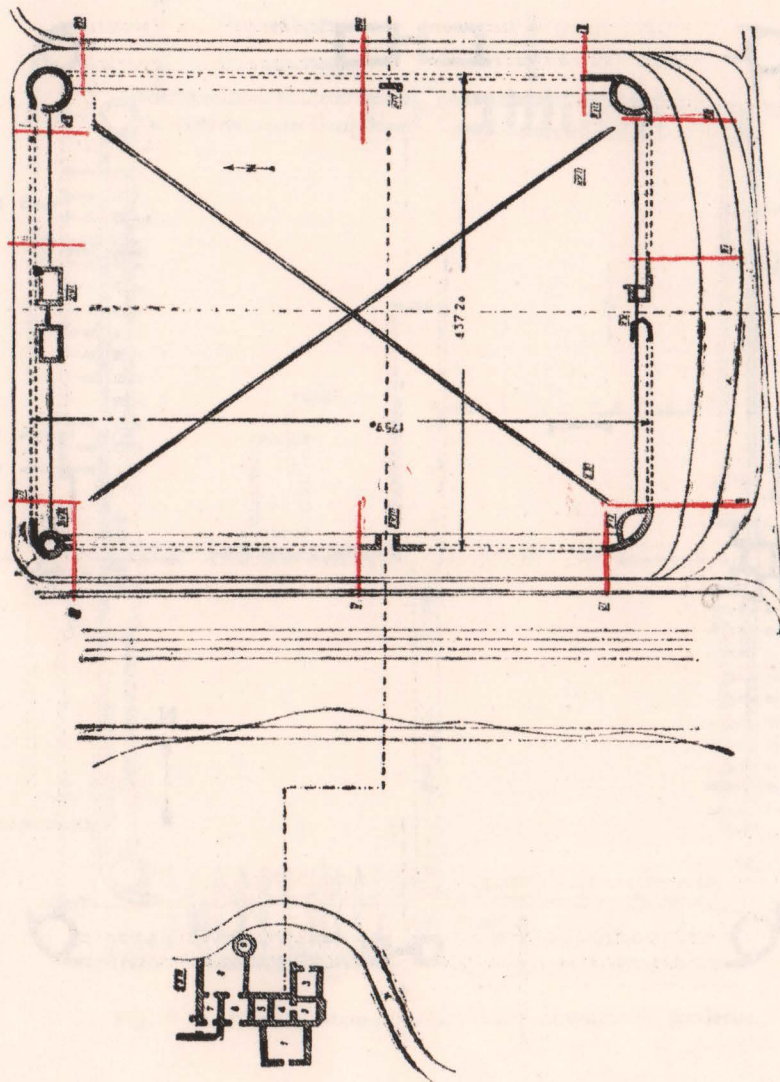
Planul castrului (după Em. Panaiteșcu)
